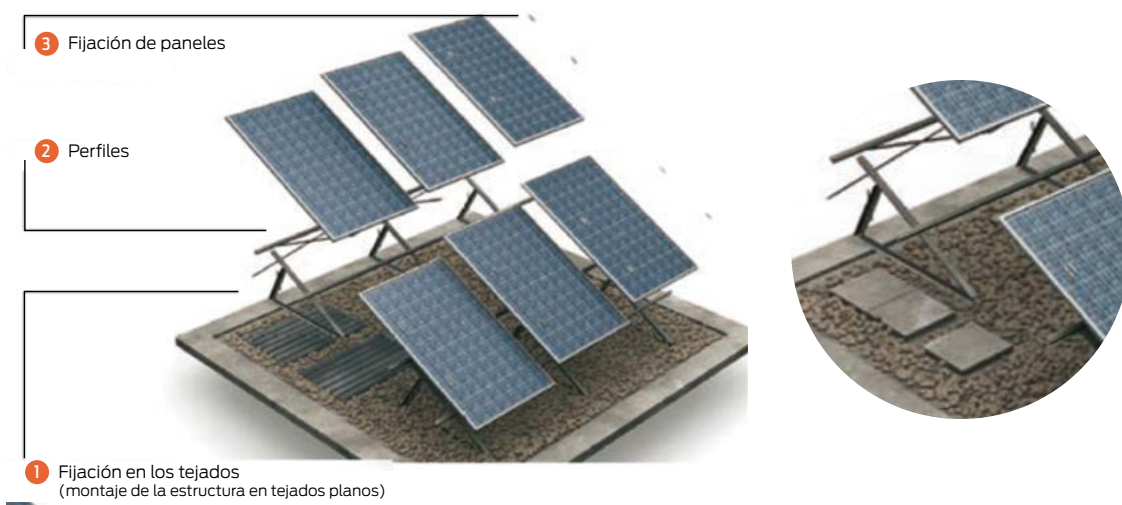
Estructuras en tejados planos / Fuente: (Donauer Solartechnik Vertriebs GmbH, 2009)
